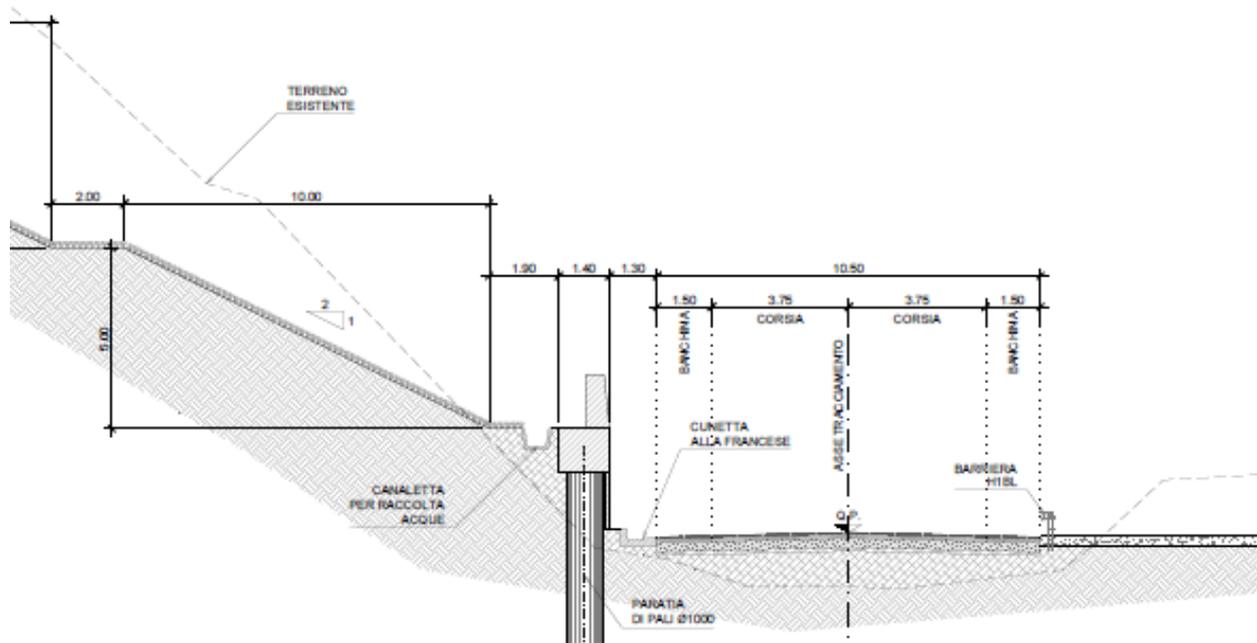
Riprofilatura scarpata esistente – sezione tipo.
